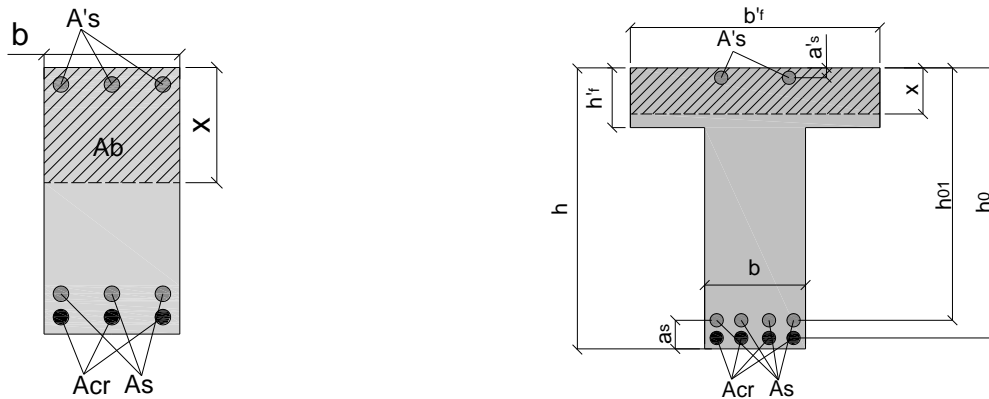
Формы поперечных сечений изгибаемых железобетонных элементов с комбинированным армированием металлической и полимерной композиционной арматурой (разработано автором)
